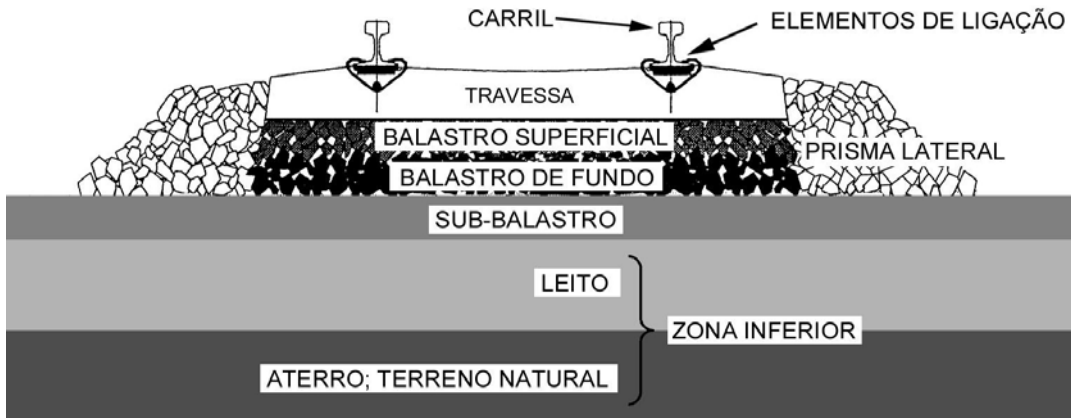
Esquema estrutural em corte transversal da via balastrada (Fortunato, 2005)
